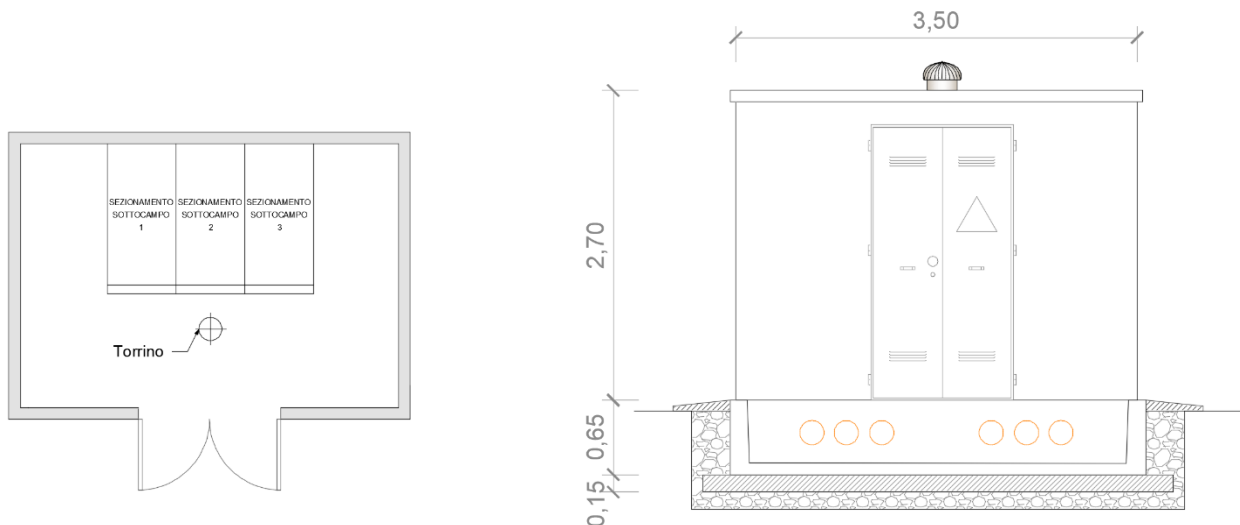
Planimetria e prospetto frontale Cabina di sezionamento
